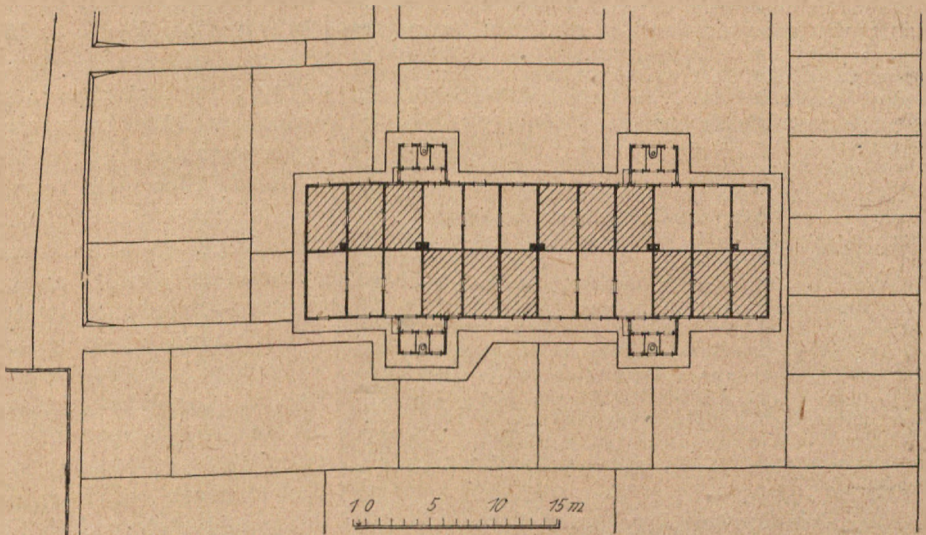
Aufteilung einer Holzbaracke in acht Wohnungen.
